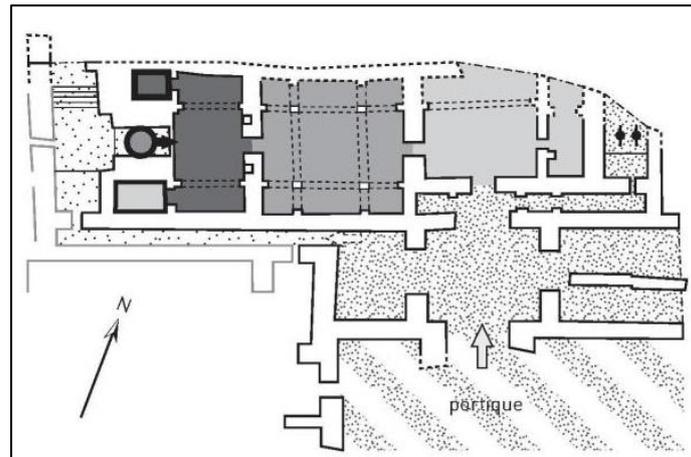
Plan du bain califal. Source FOUNIER³¹¹
